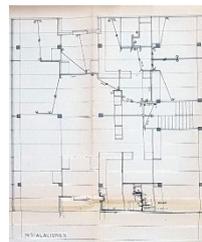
Plantas Instalaciones B-3-4. 1964. Fuente: Archivo Municipal da Coruña
